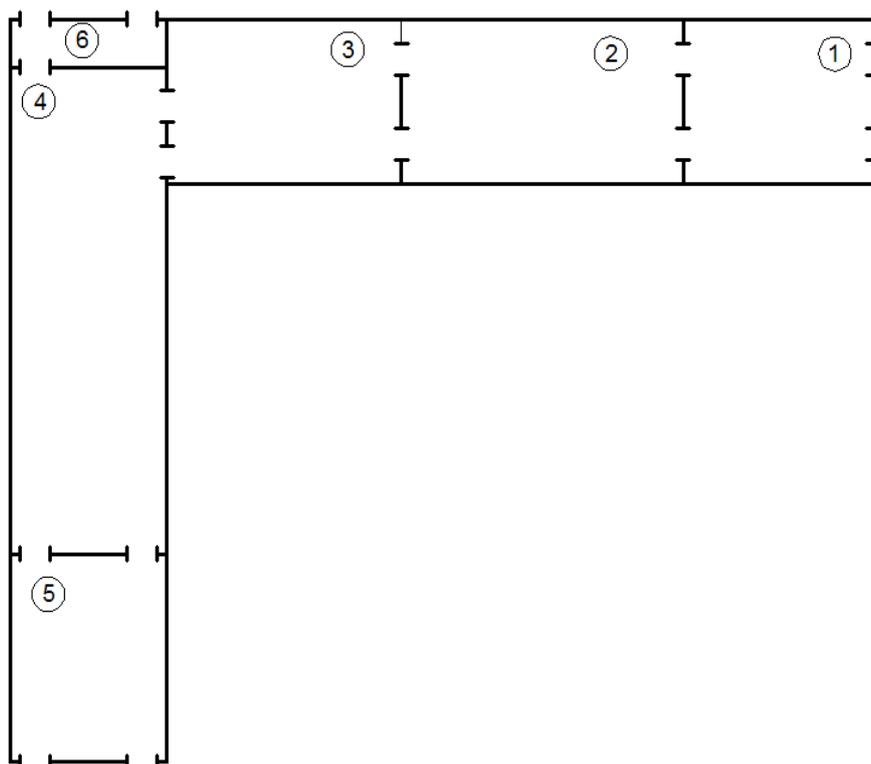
Схематичное расположение отделений главного корпуса автозавода при «Г»-образном блокировании корпусов
